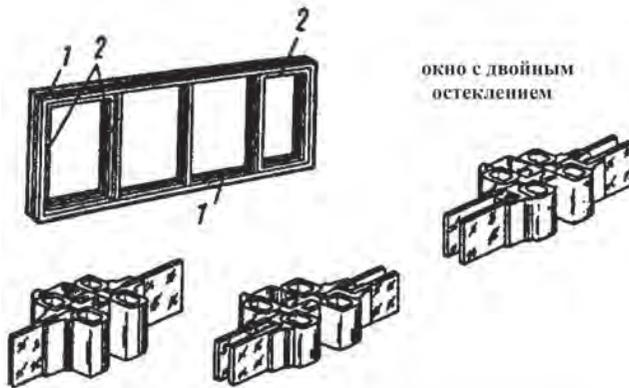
Конструкция окна из спаренных прямоугольных труб с фрамугами:
